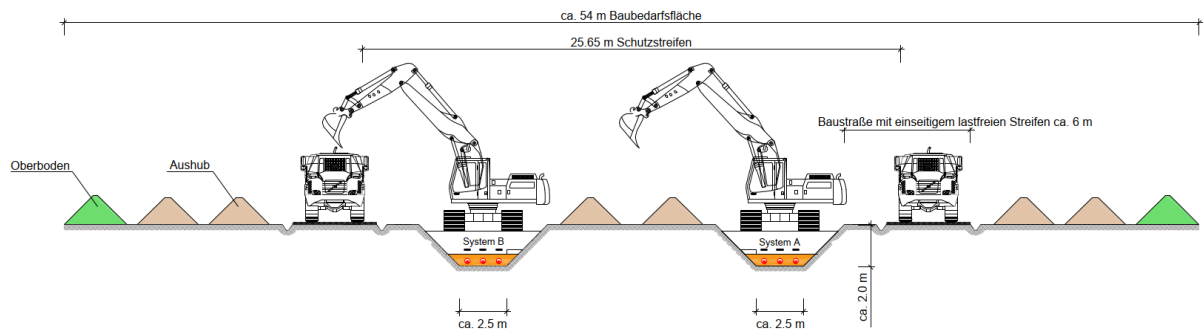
Grabenprofil offene Bauweise mit zwei Baustraßen
